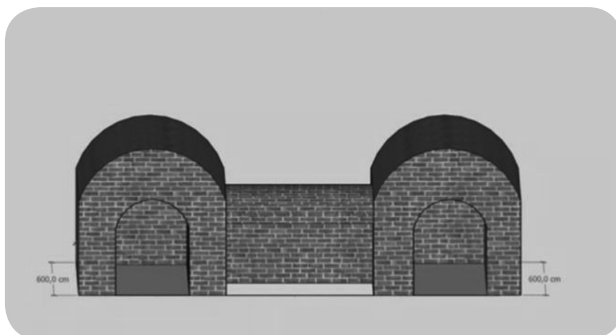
Bagian Depan Bangunan di Titik 3. Sumber: Widnyana, 2021
